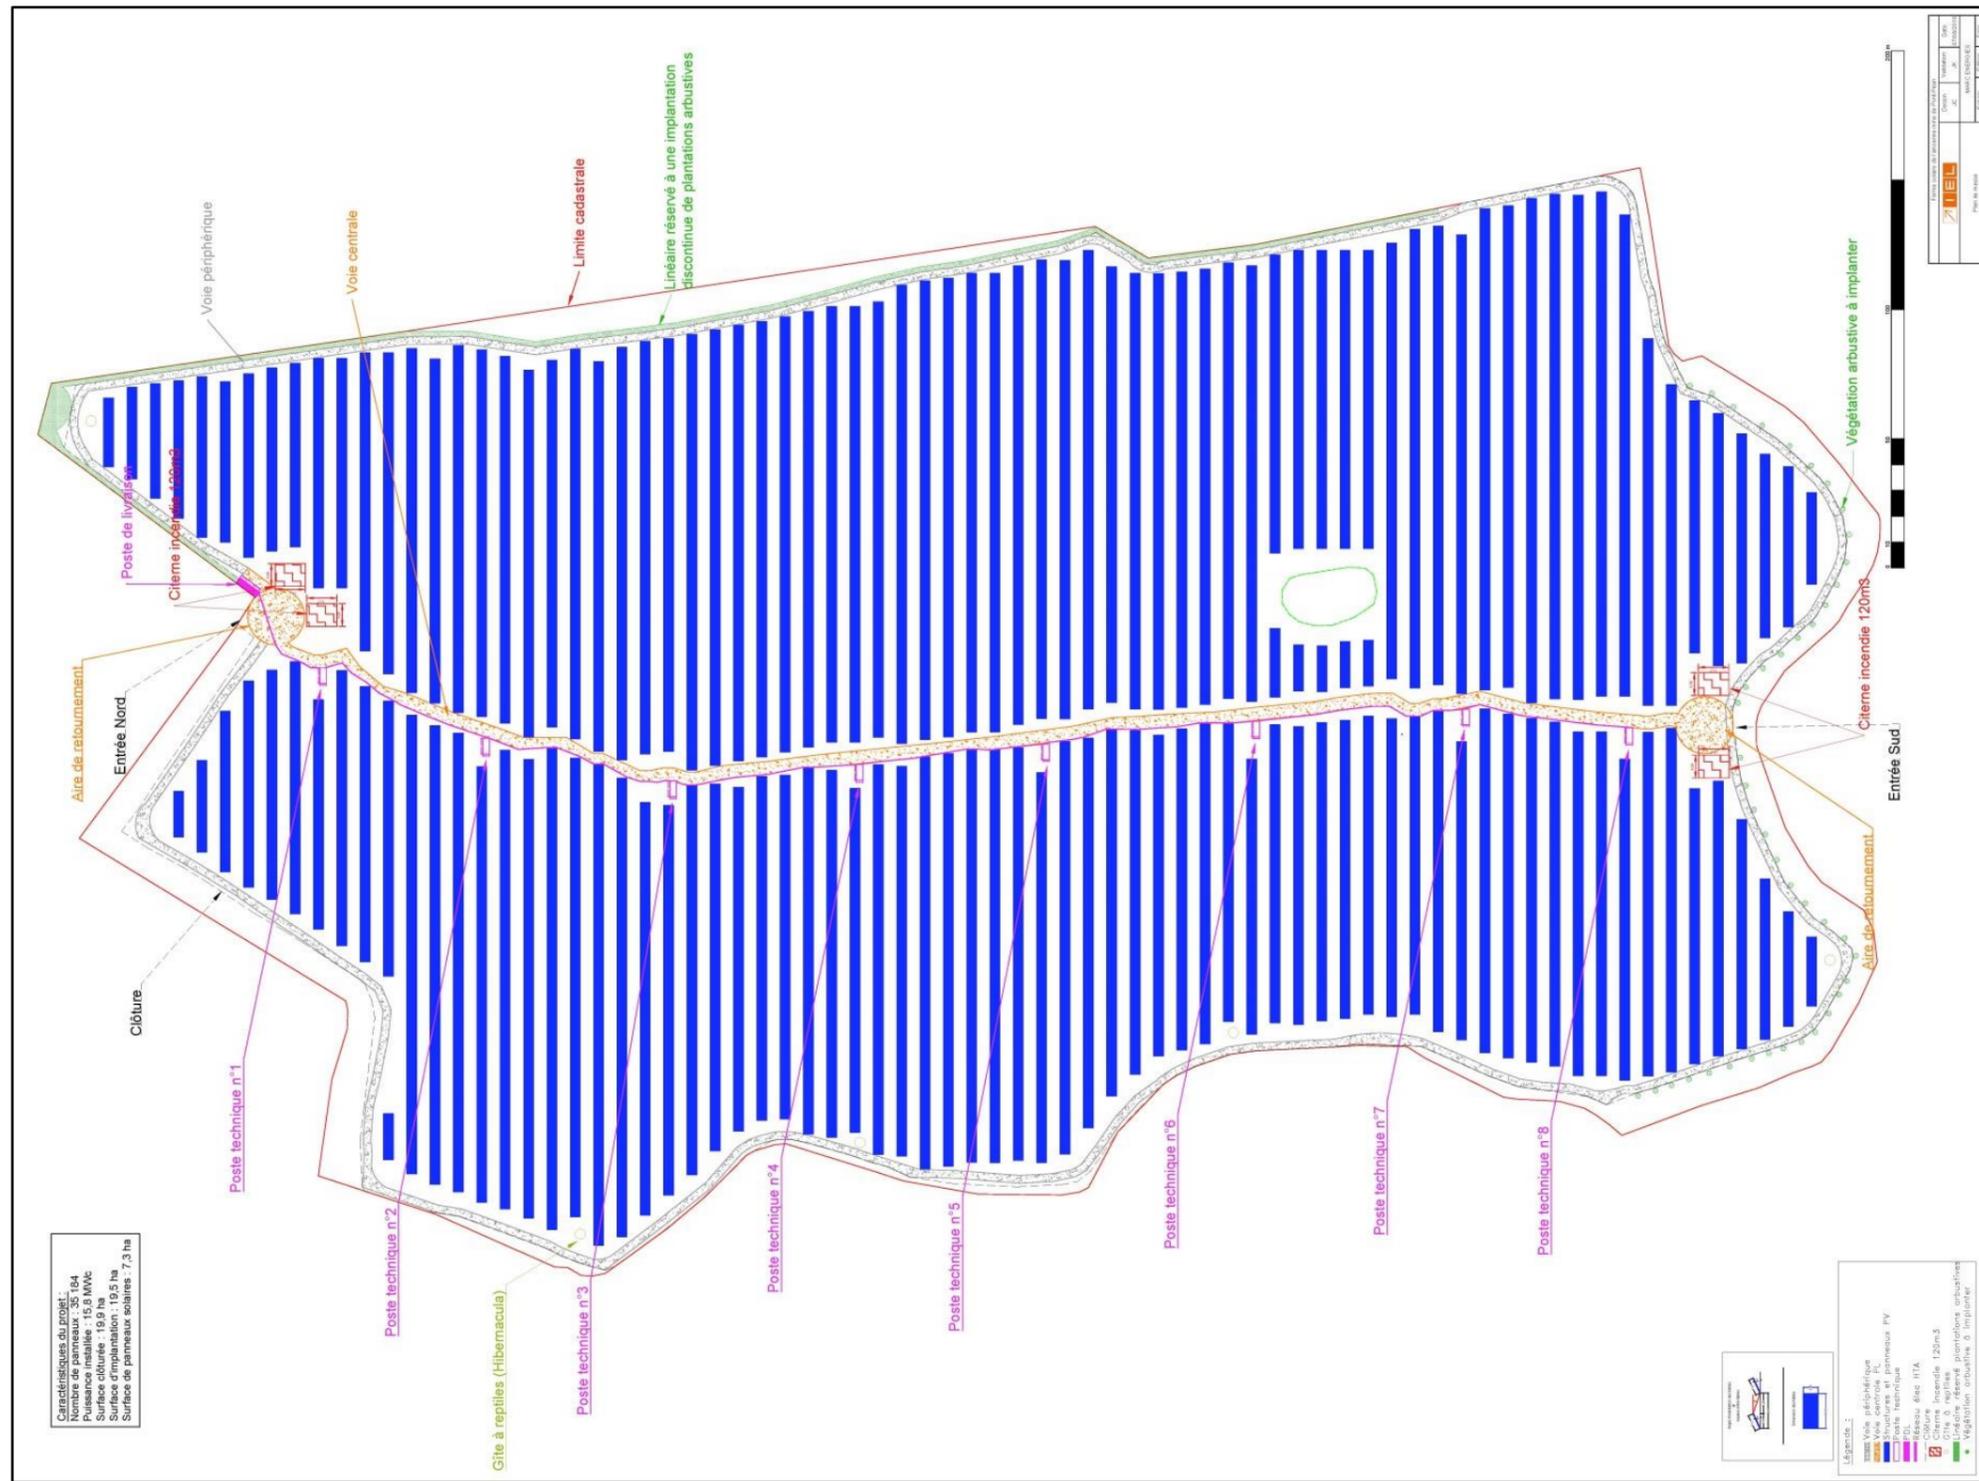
Plan d'implantation du projet de Bruz / Pont-Péan
